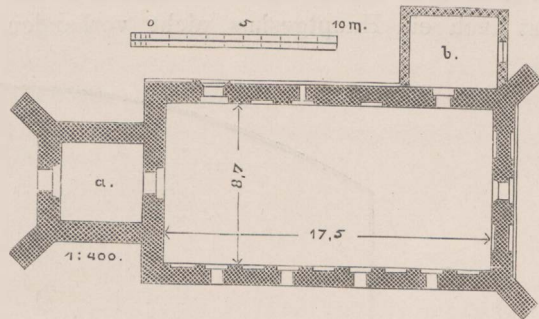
Szepanken. Grundriss der Kirche.
